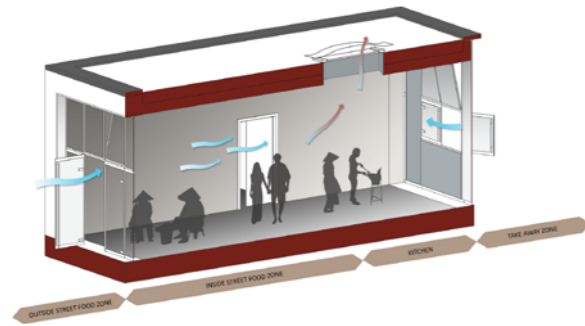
Aperture e ventilazione nel blocco dello Street Food
